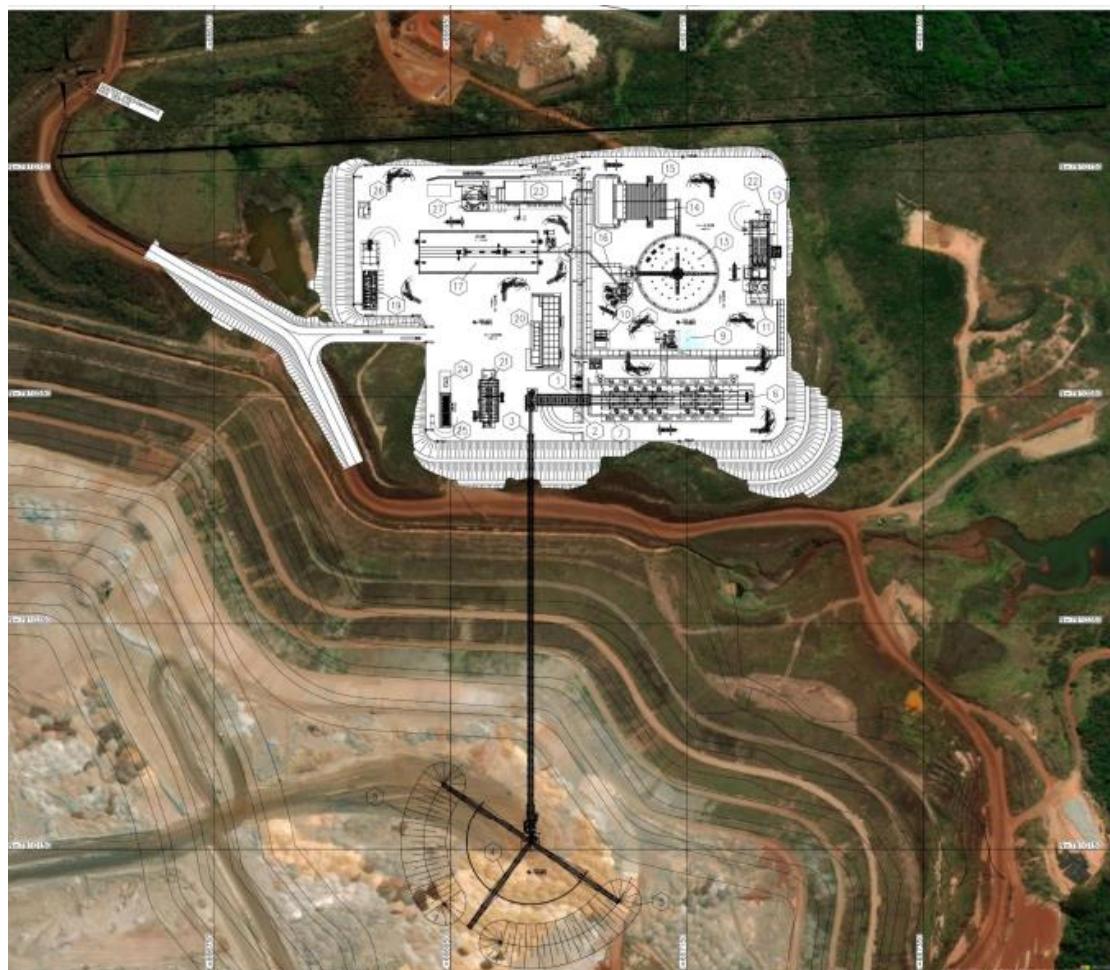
Projeto da Planta de Filtragem de Rejeitos (em anexo com detalhes)
